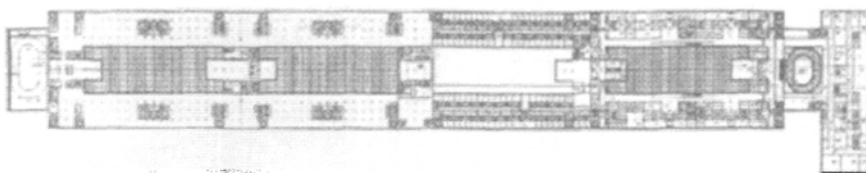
意大利菲亚特 Lingotto 工厂一层平面图
